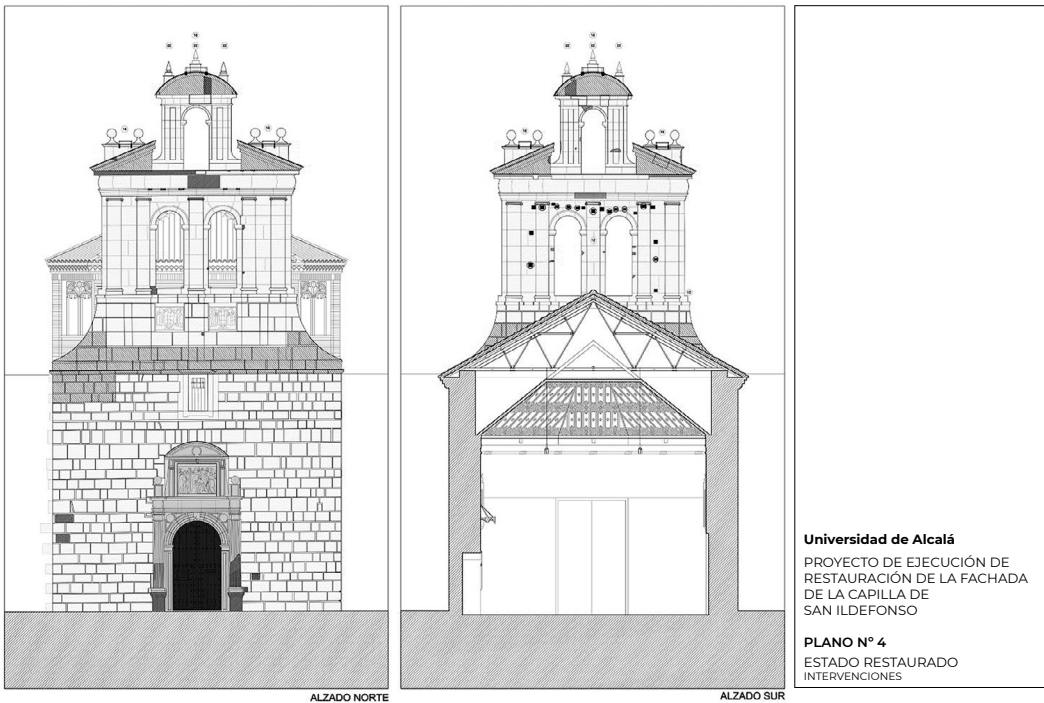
Proyecto de restauración: Plano de intervenciones. 2018.
